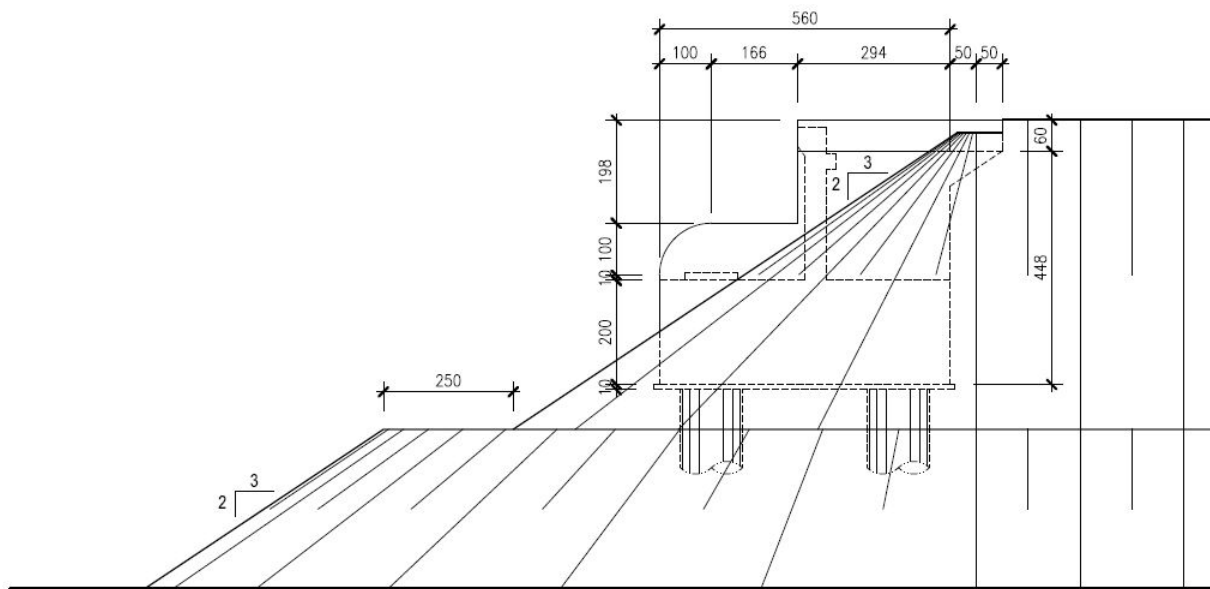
GEOMETRIA TIPO SPALLA APERTA
